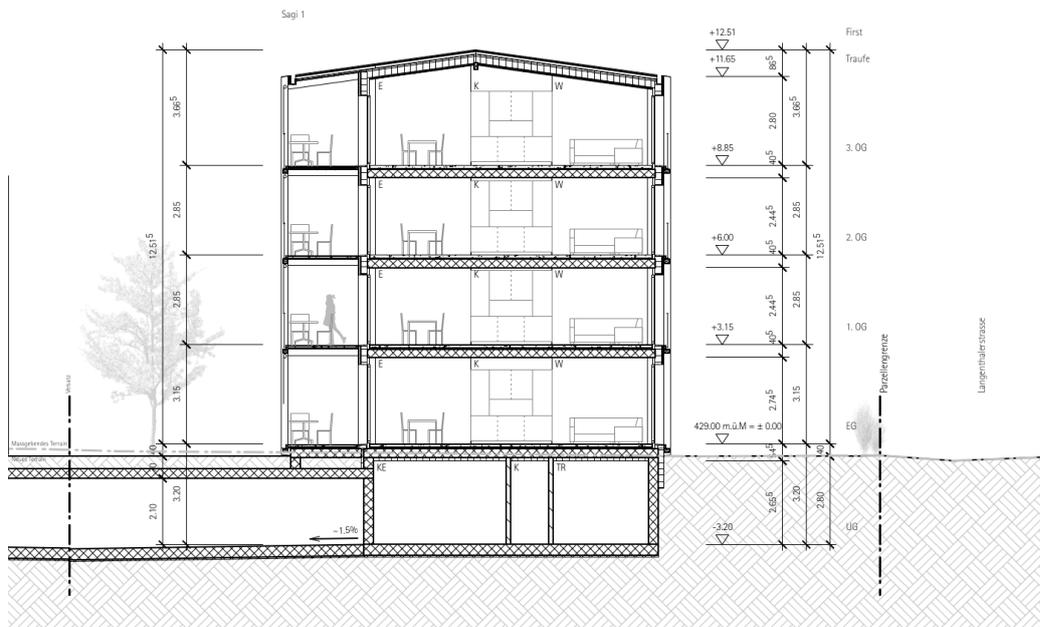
Querschnitt Gebäude Sagi 1 mit vier Geschosse.
